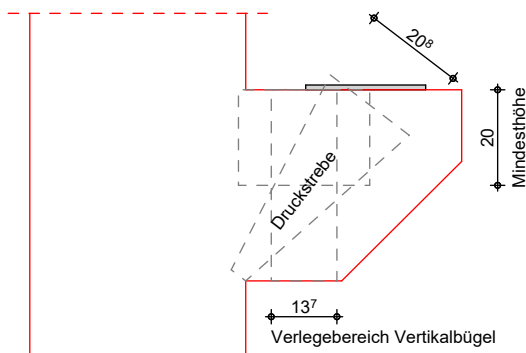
Mindestabmessungen der Konsole mit schräger Unterkante
